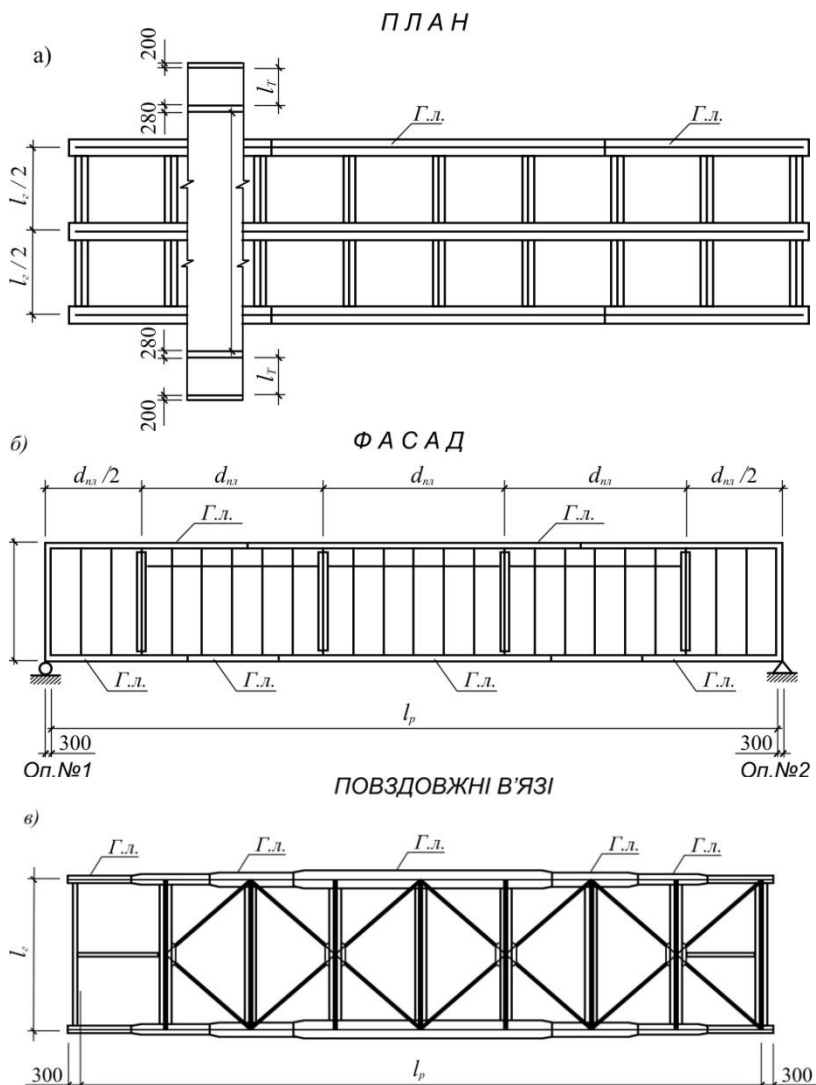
План (а), фасад (б) та поздовжні проєкції прогонової будови моста (в)
